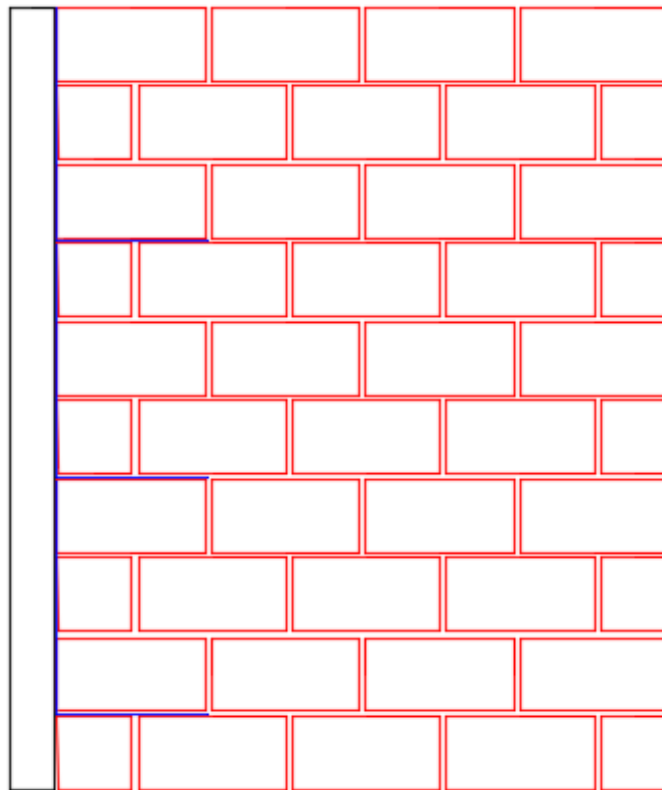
Aplicação de telas metálicas para fazer a ligação alvenaria-estrutura
